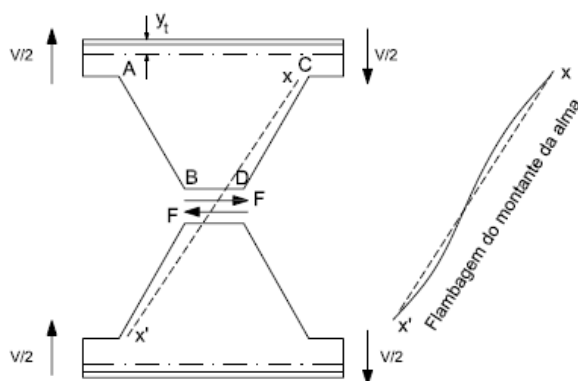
FMA em viga castelada (adaptado de Kerdal e Nethercot, 1984).
